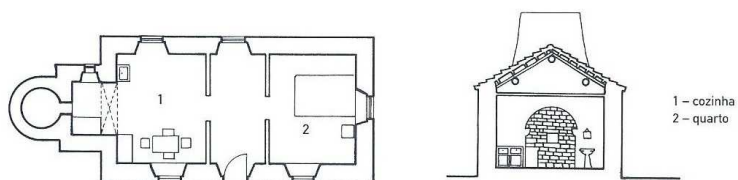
Planta e corte casa janela-porta-janela (APDA)
